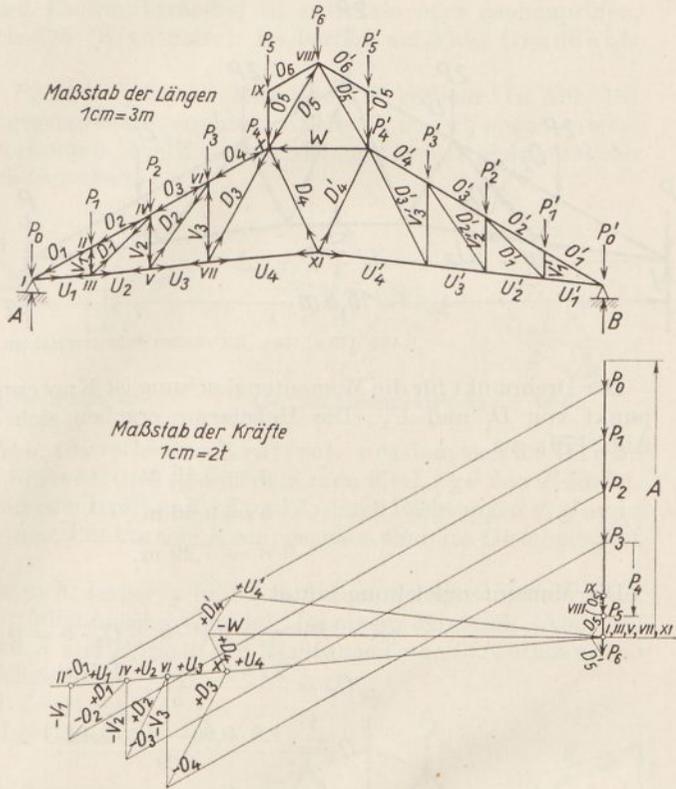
Binder mit Dachreiter und Cremonaschem Kräfteplan.
